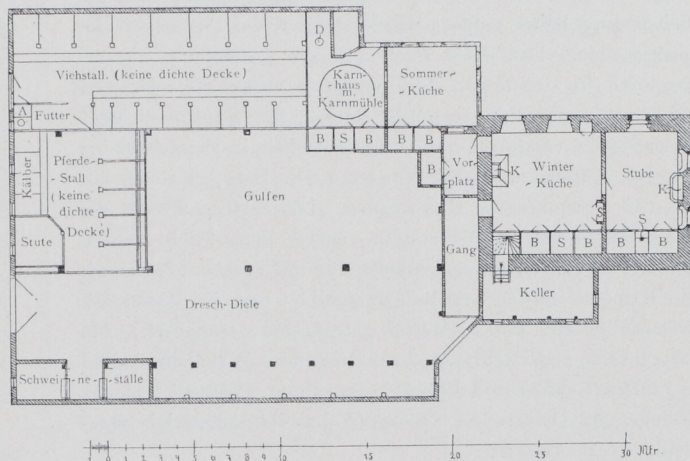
Platzgebäude in Stapelmoor. Grundriß.
